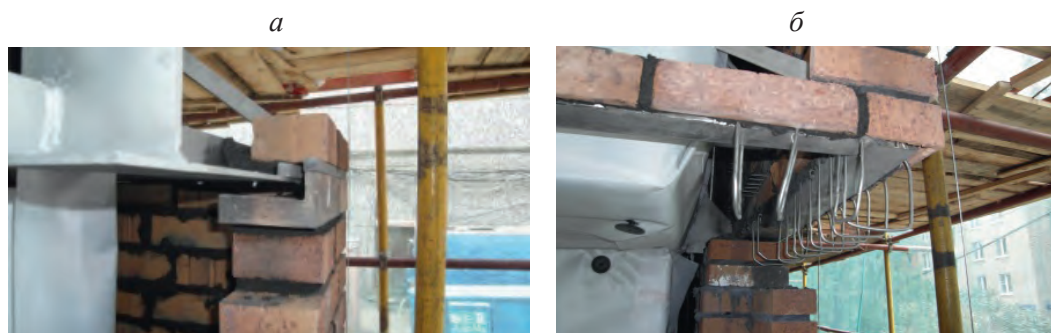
Производство работ при устройстве кирпичной облицовки на фасаде
